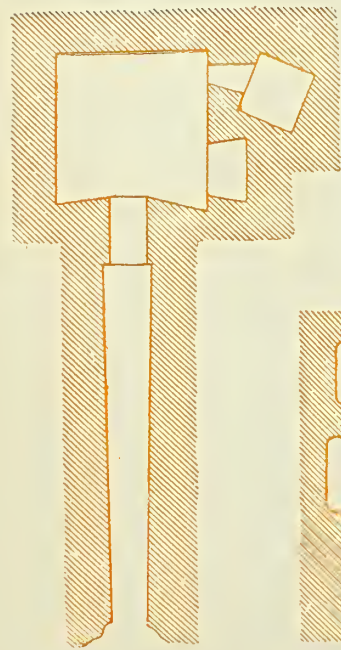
PLANTA DE UNA FOSA CAVADA EN LA ROCA CON DOS CÁMARAS LATERALES.
